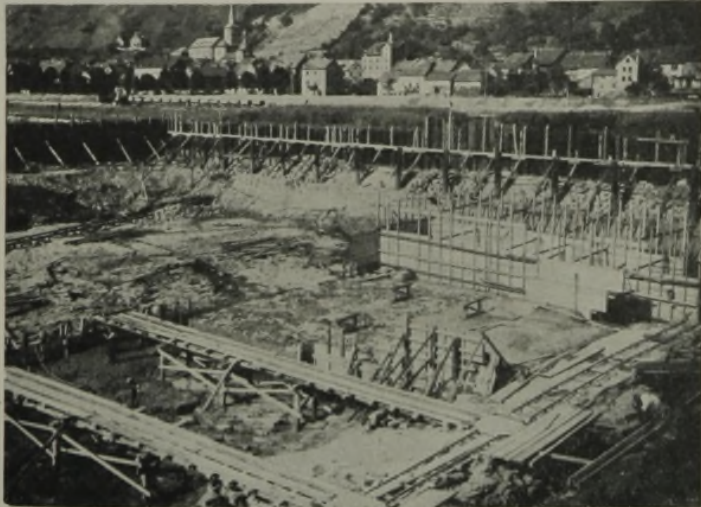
Staustufe Klingenberg—Trennfurt. Linke Wehrröfnung während der Betonierung.
